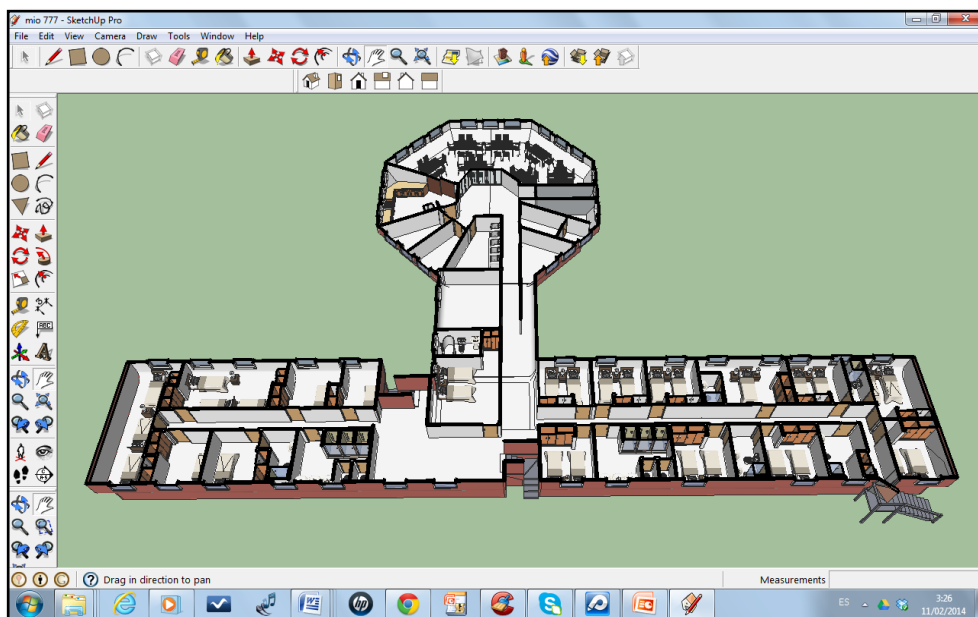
Ubicación de divisiones internas y muebles en estructura externa. Detalle de módulo completo
